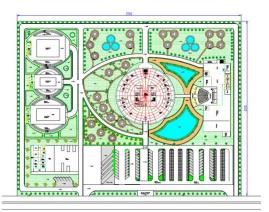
Denah lantai 1 *Fire and Protection System*(Sumber : Pengembangan Desain)
